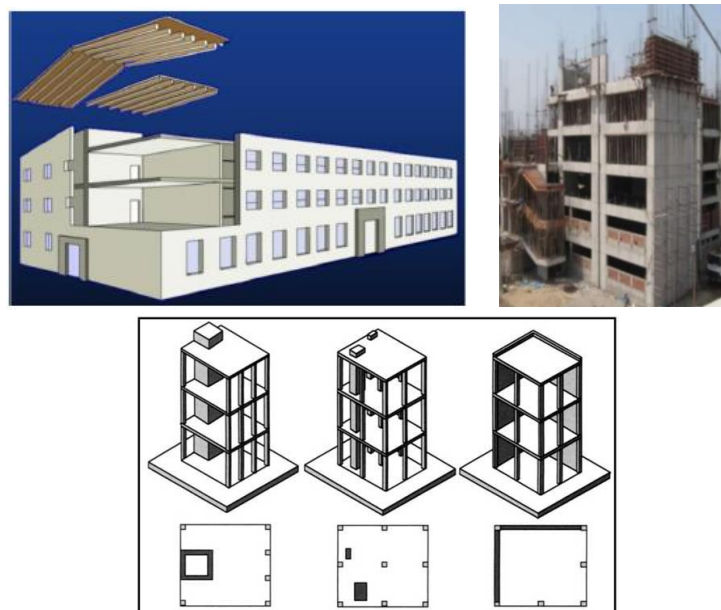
Pórticos de Hormigón Armado con Muros Estructurales (C2).
